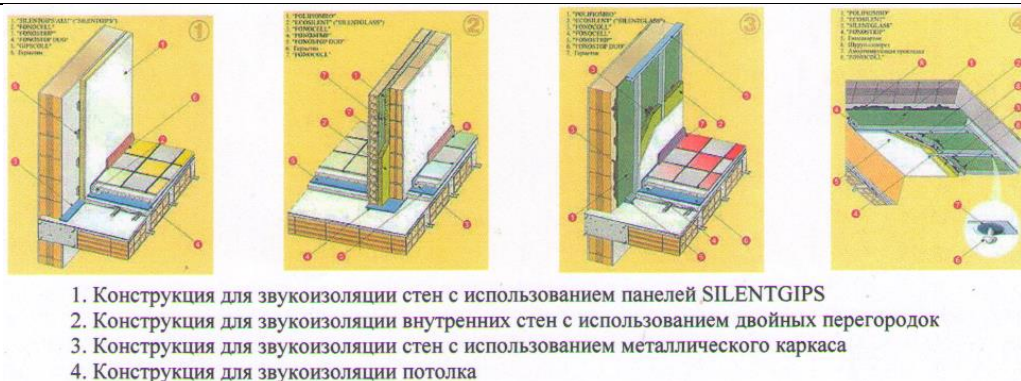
Звукоизоляционные конструкции для стен и потолка
